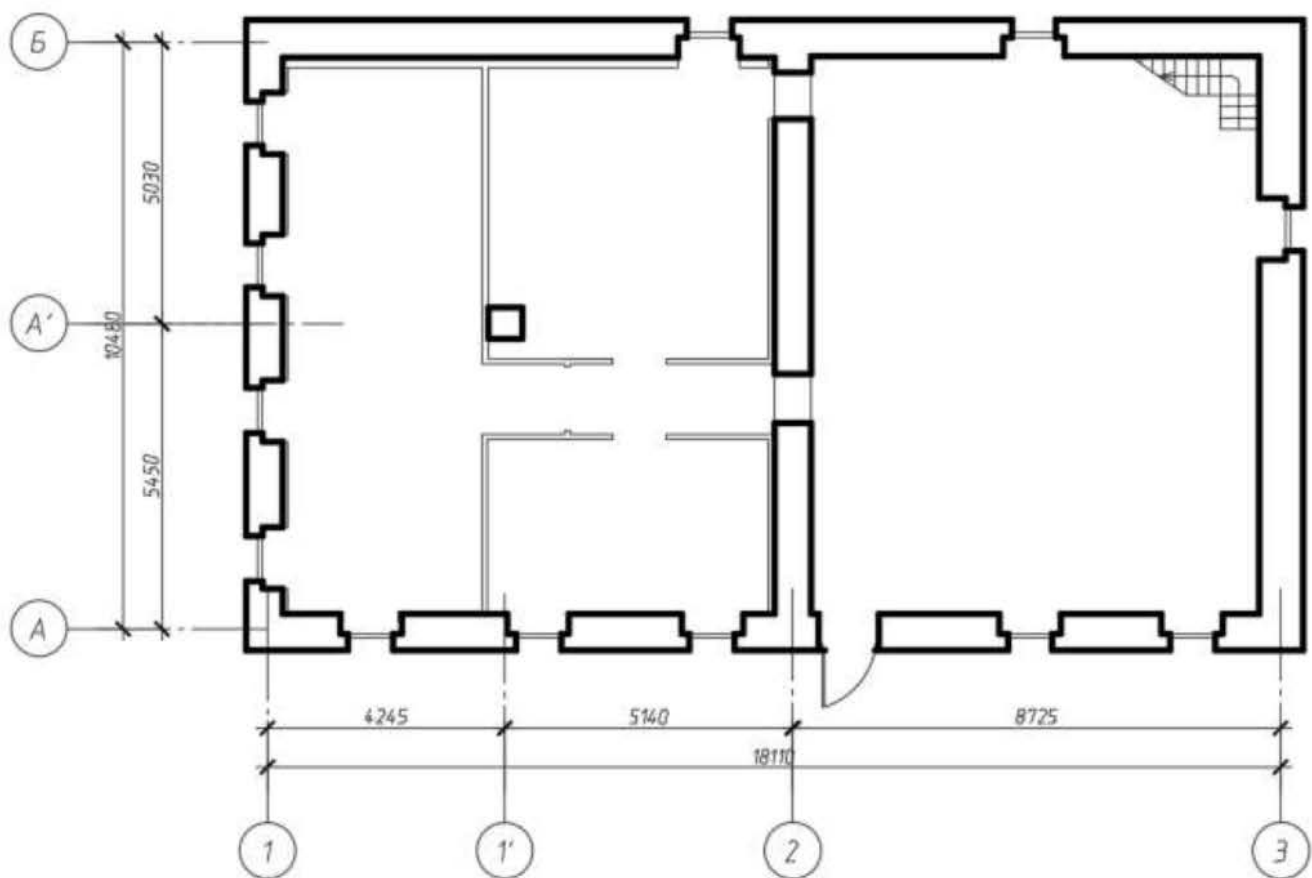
План-схема цокольного этажа здания с обозначением осей
